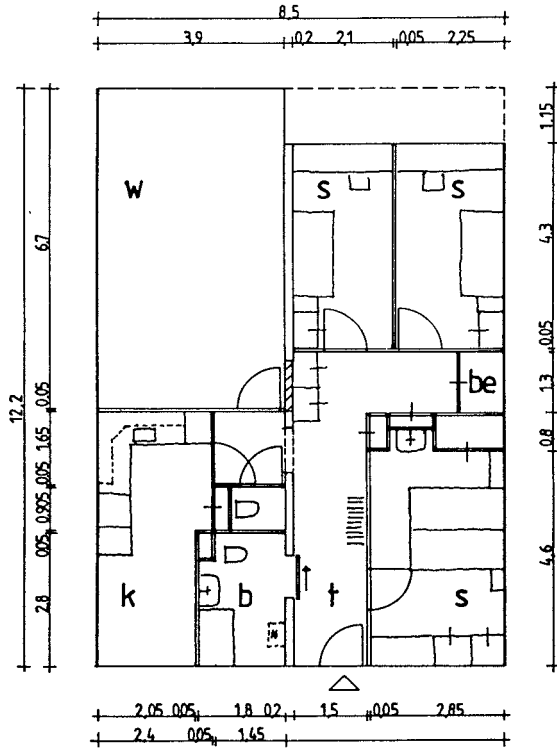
Plan du rez-de-chaussée d'une maison familiale à Oosterhout - adaptation à l'intention d'un handicapé en chaise roulante, capable d'utiliser ses bras et ses mains et de prendre soin de son ménage. Légende: T = hall d'entrée, W = salle de séjour, S = chambre à coucher, K = cuisine, B = salle de bains/toilettes, Be = réduit.
